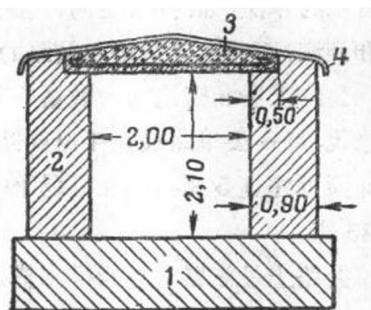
鋼筋混凝土蓋版混凝土箱涵構造
